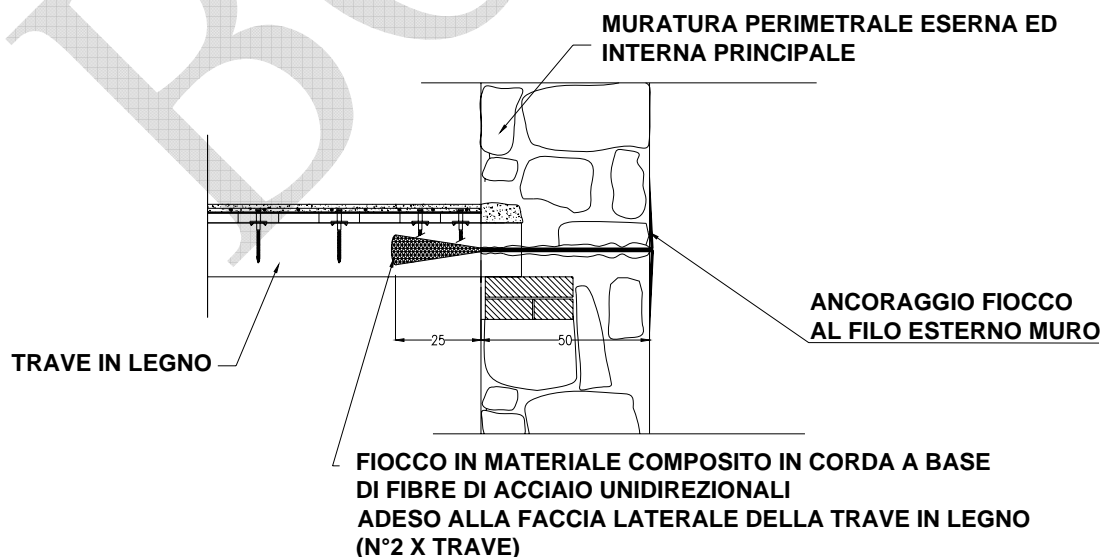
Ancoraggio laterale: soluzione con fiocco in fibra metallica passante
